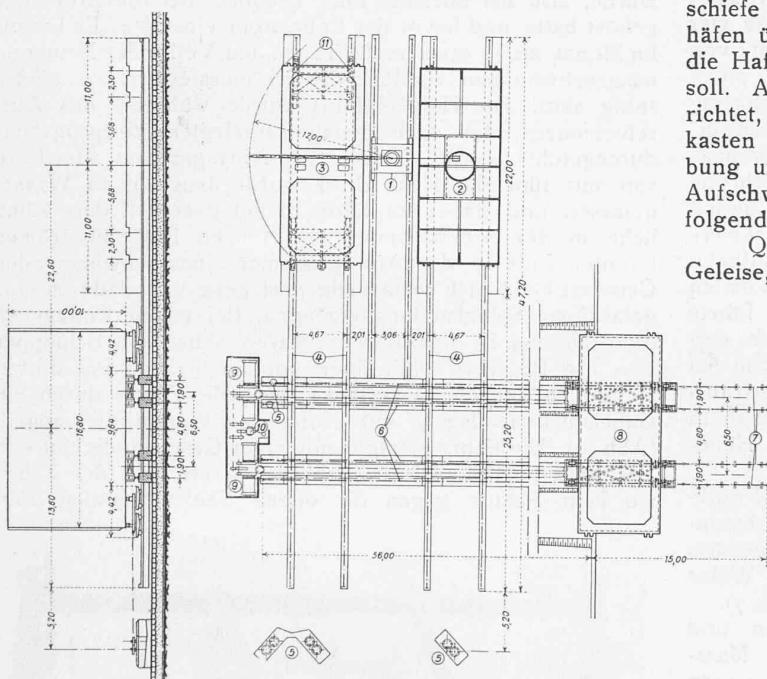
bis 4. Anlage zum Herstellen und Zuwasserlassen der Eisenbetonsenkästen; Grundriss und Schnitt. Maßstab 1:600.
